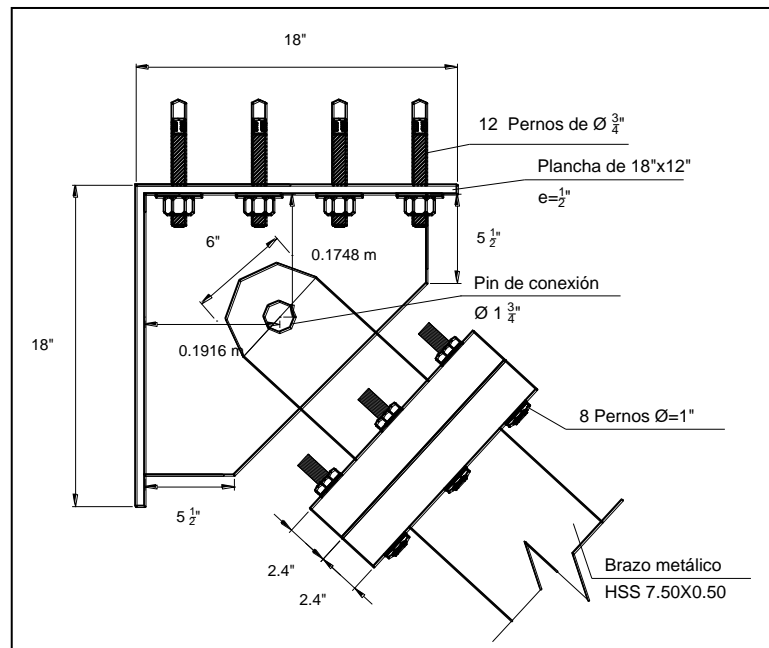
Detalle 02 (conexión brazo metálico – cartela - estructura de concreto).
